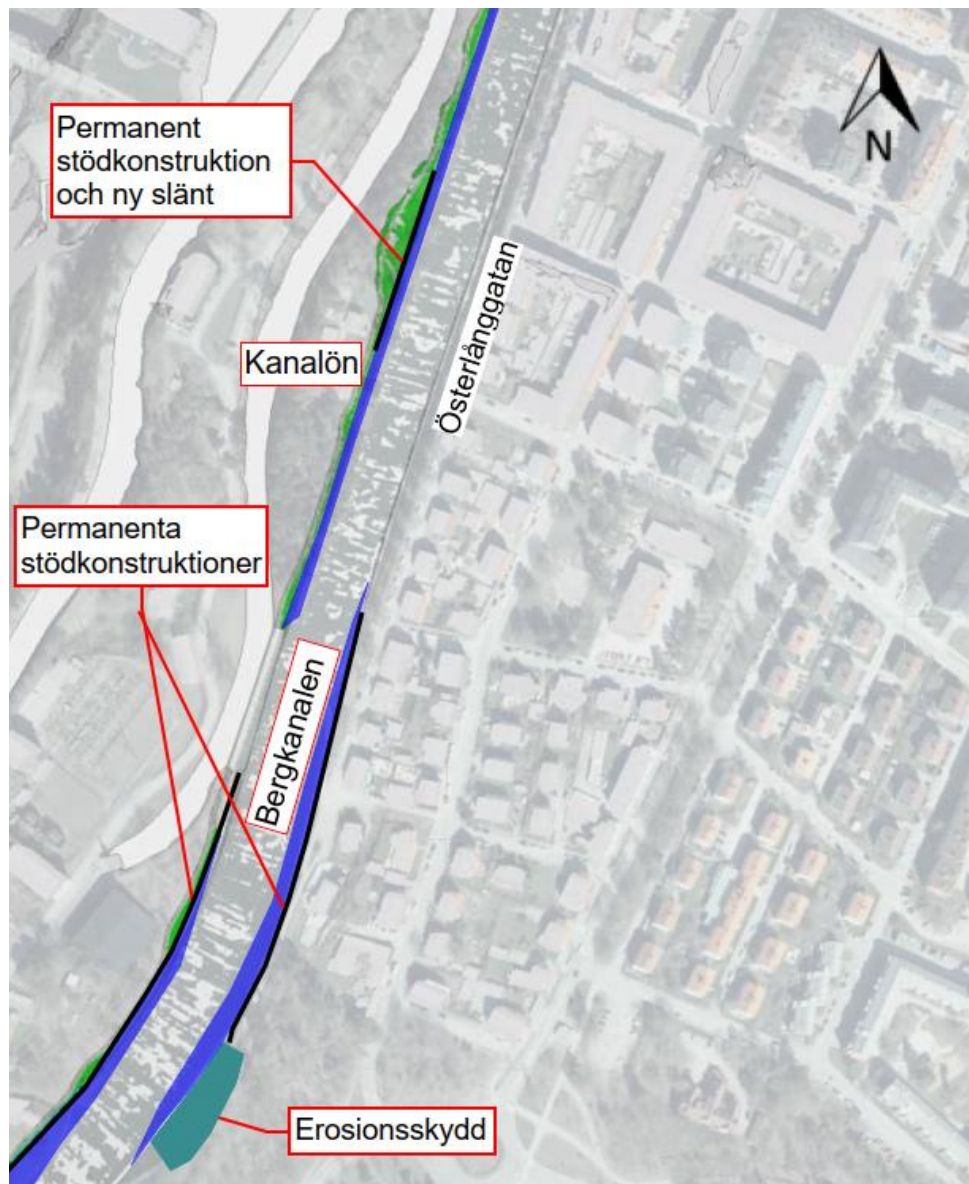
Planerade anläggningar mellan Göta älv och Bergkanalen.
